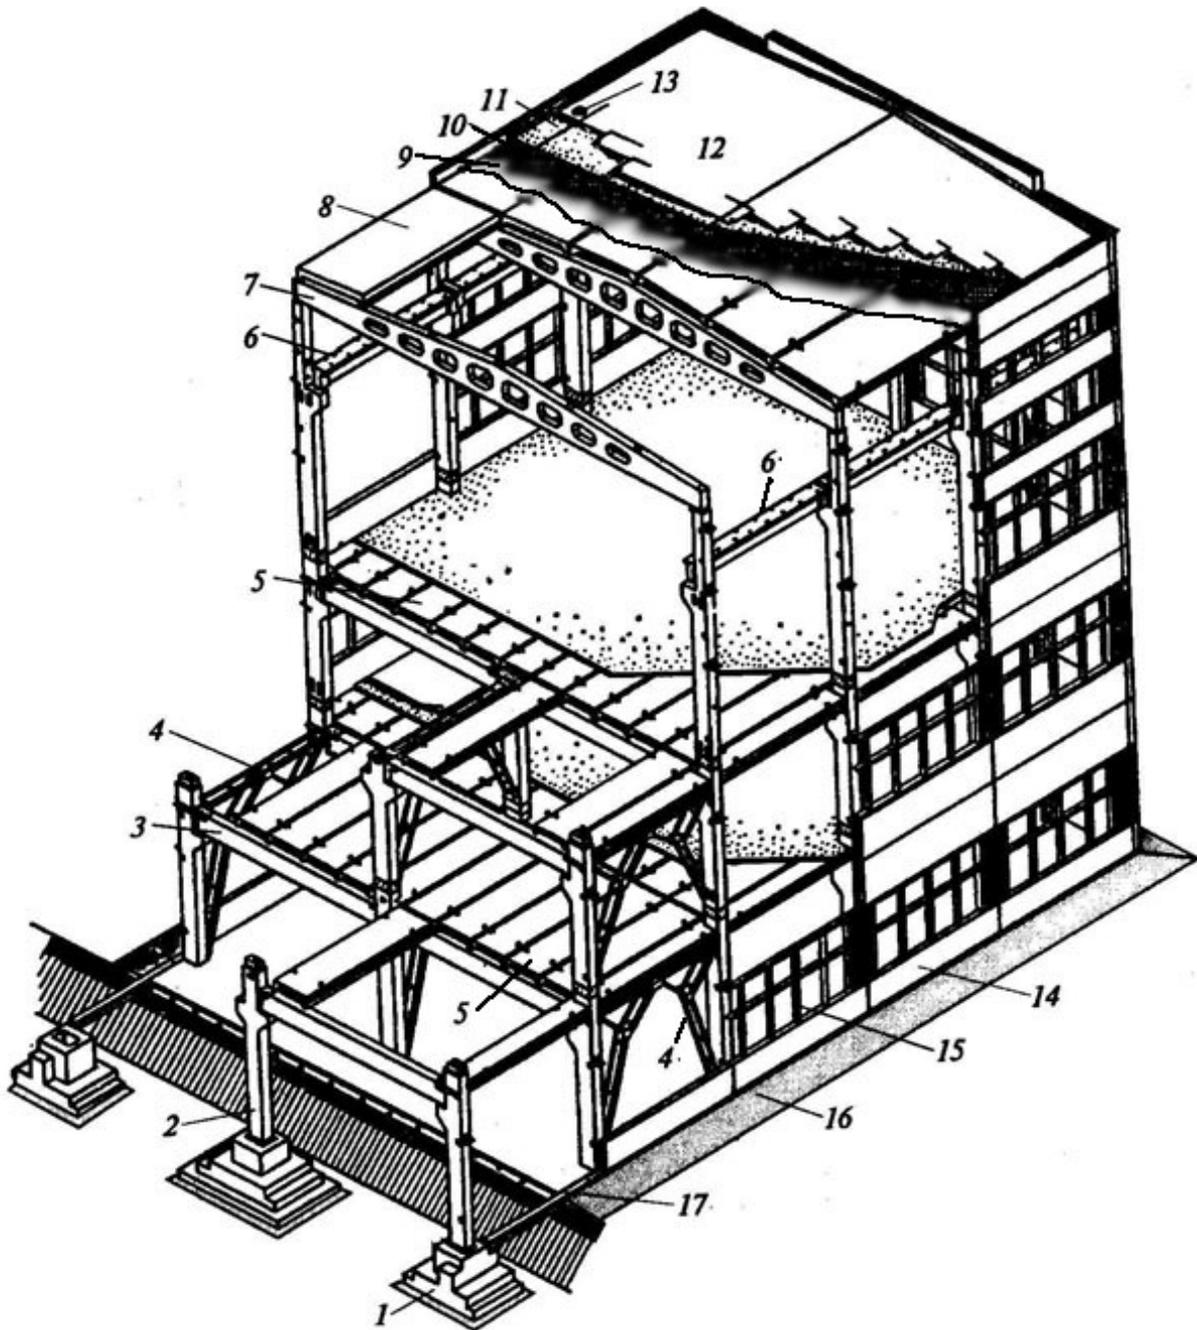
Основные элементы многоэтажного здания с рамным железобетонным каркасом:
